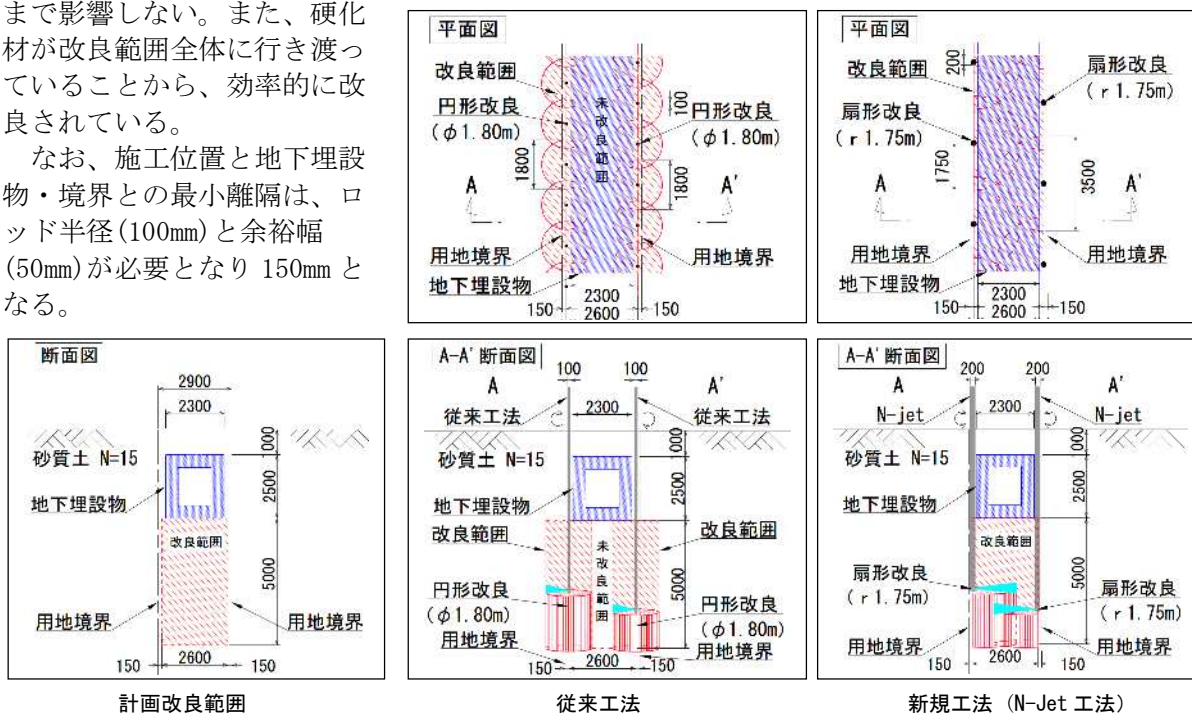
地下埋設物や用地境界を考慮した場合の従来工法とN-Jet工法の改良体配置比較
